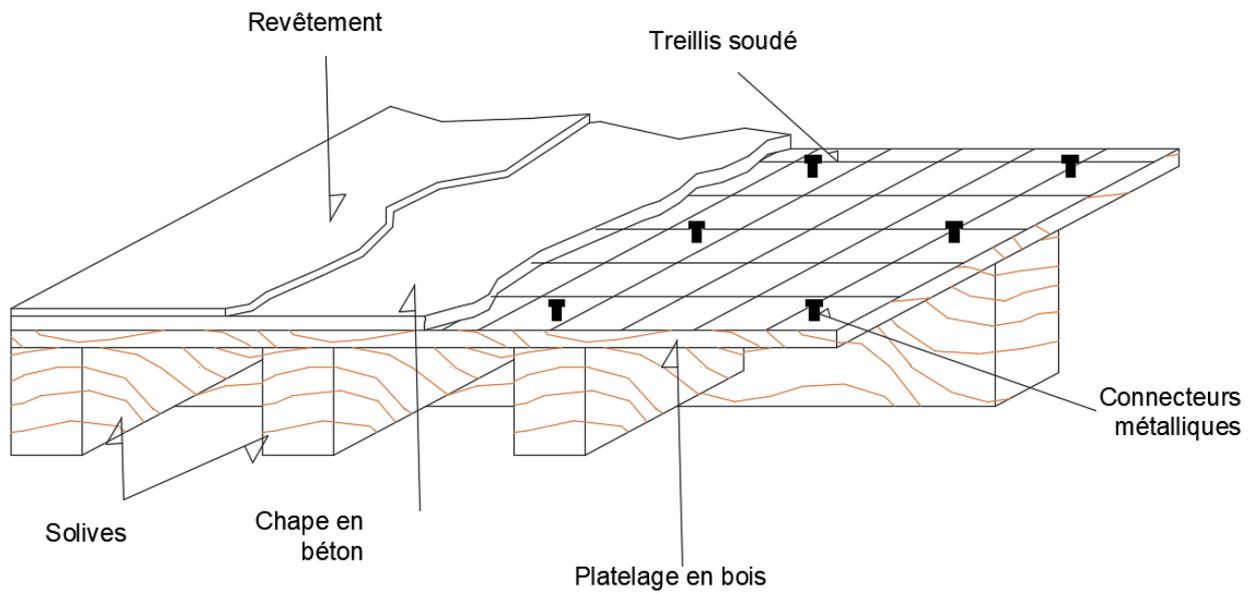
Détail plancher mixte bois-béton. Source : Auteurs.
